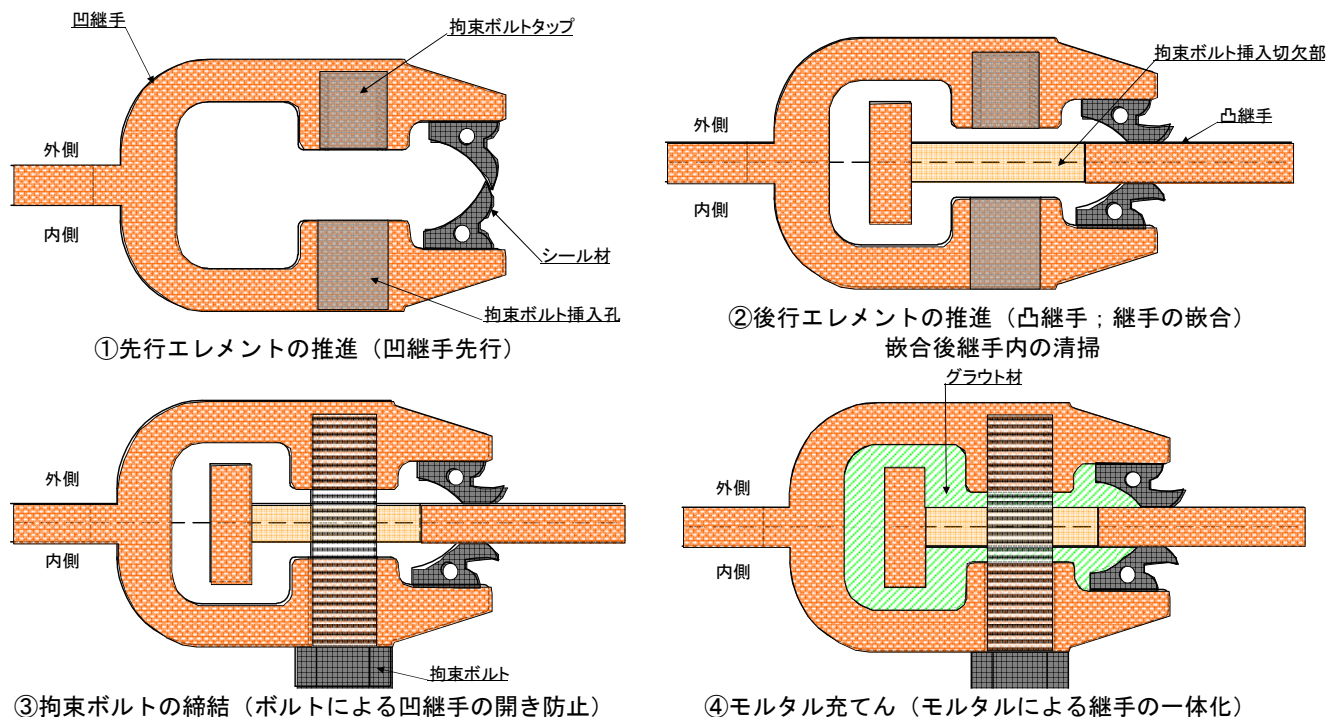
ボルト拘束型モルタル充てん継手の概要と施工手順
